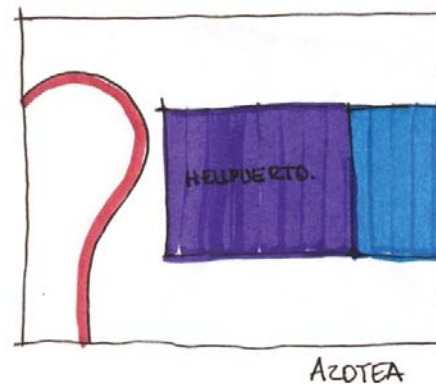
Esquema de disposición Estación de Bomberos "Ave Fénix". Planta de Azotea. Croquis personal
